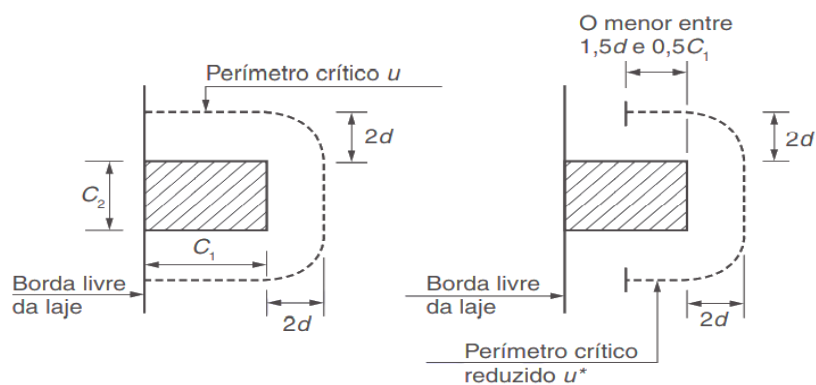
Perímetro crítico em pilares de borda. (NBR 6118:2014)
